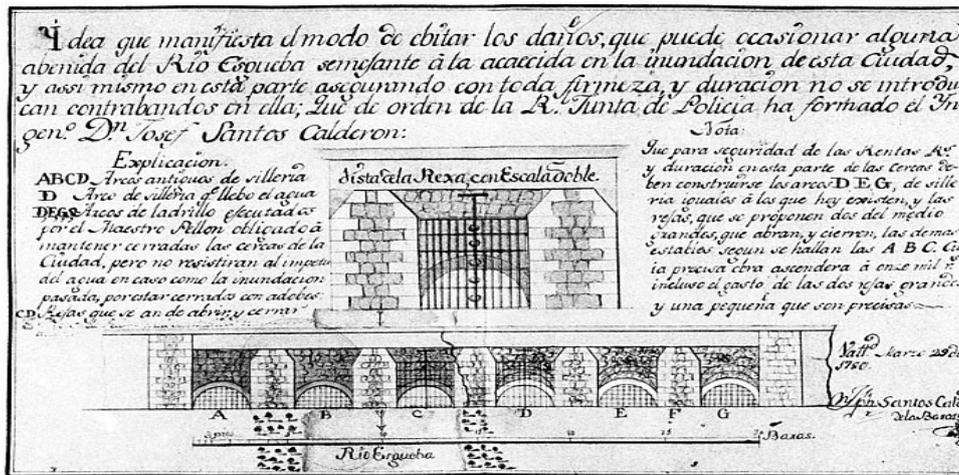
Proyecto arreglo cerca destruida del Prado de la Magdalena.
